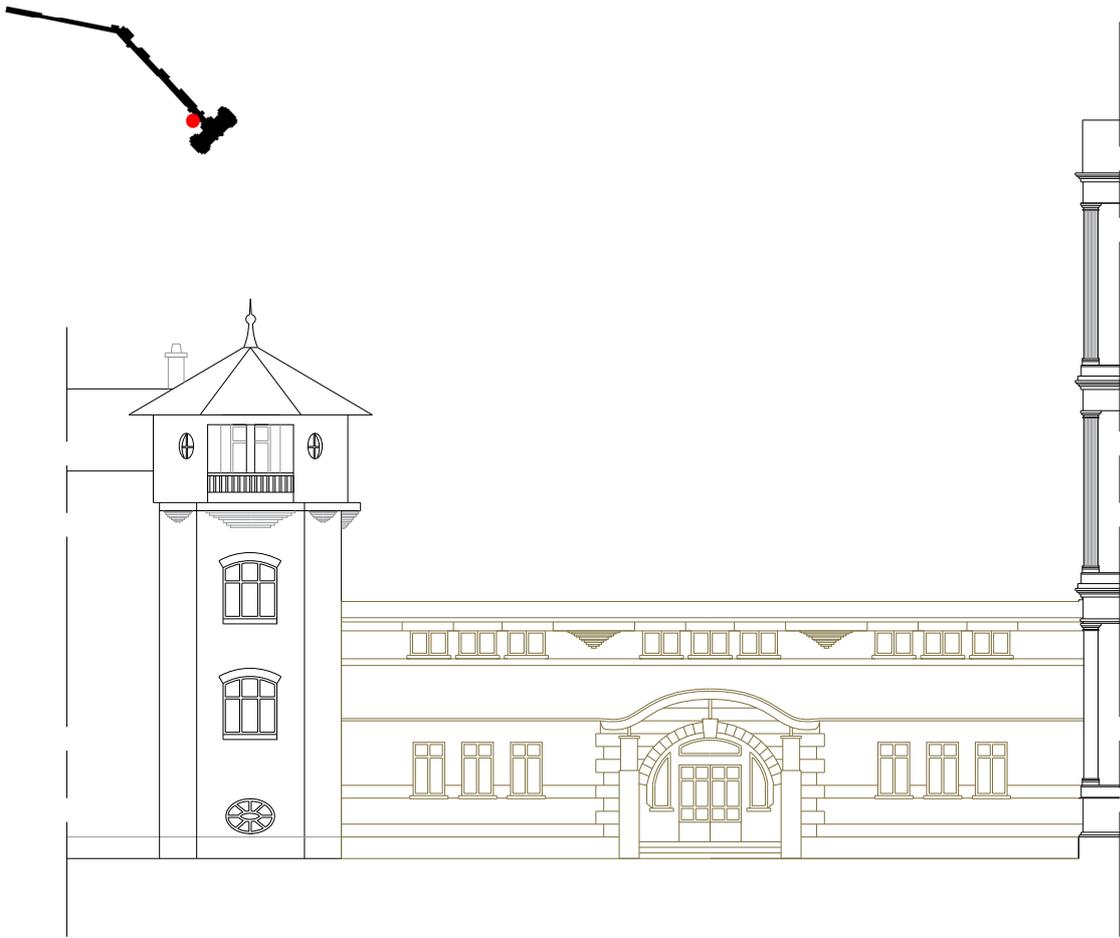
façade principale de la jonction originelle entre le pavillon et le château par J. Adamo d'après les archives du CH de Carnelle, échelle 1/200.
